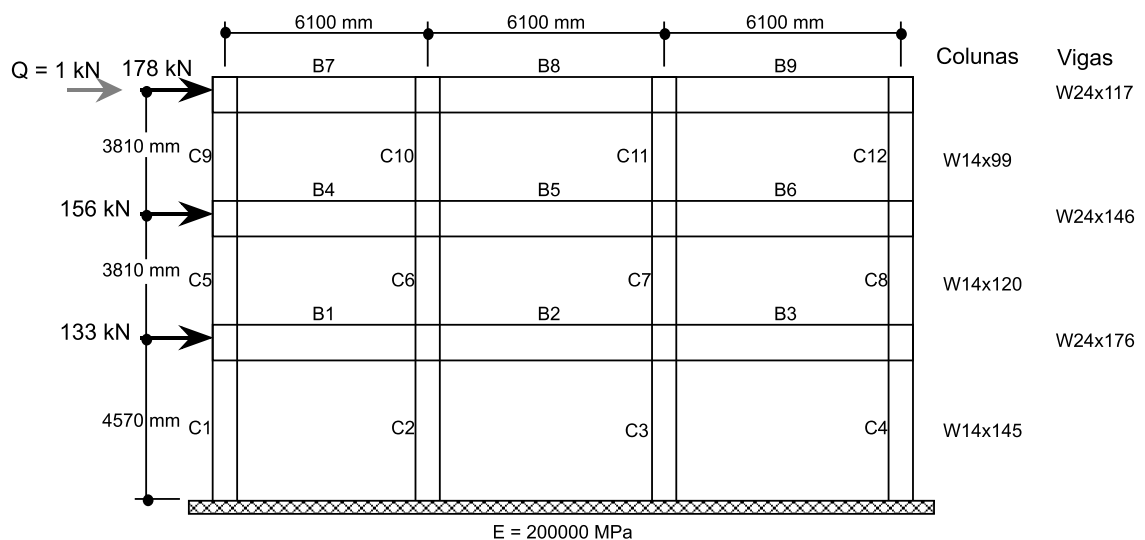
Pórtico plano rígido (adaptado de Charney, 1993).
